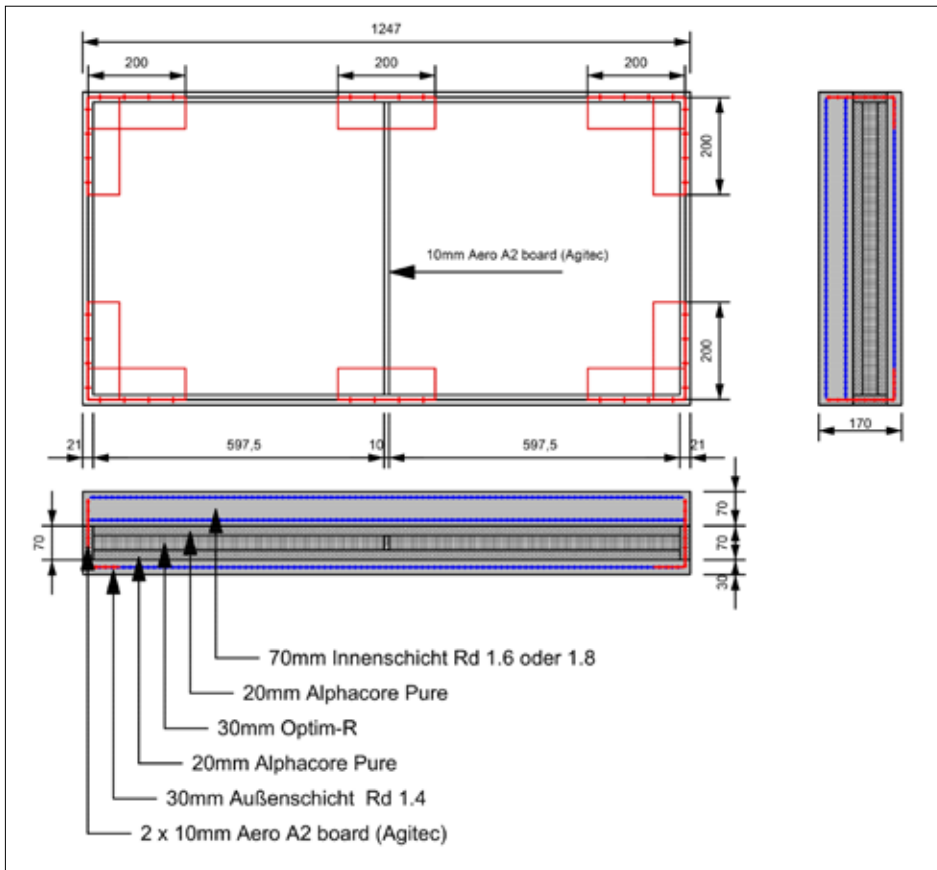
Fassaden-Sandwichelement/ Funktionsmodell fm.l.d (Meier)
